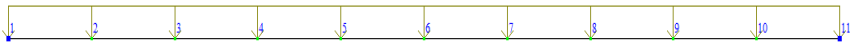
Розрахункова схема підсиленої сталезалізобетонної балки
